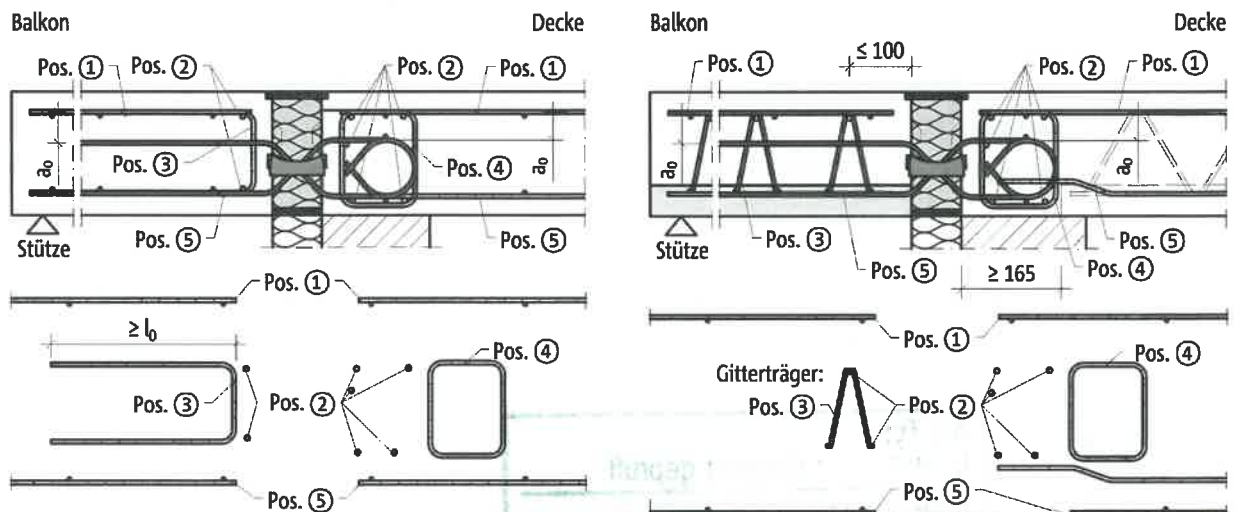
Schöck Isokorb® T Typ Q-VV1 bis -VV5 6.0, direkte Lagerung: Bauseitige Bewehrung bei Ortbetonbauweise (links) und Fertigteilbauweise (rechts) schematisch dargestellt
